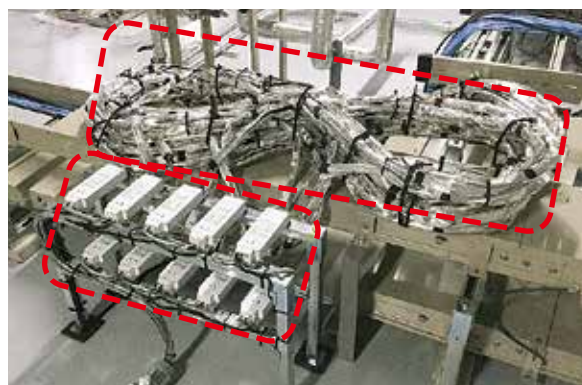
別置した電源ユニット部と静電遮蔽の施工状況
